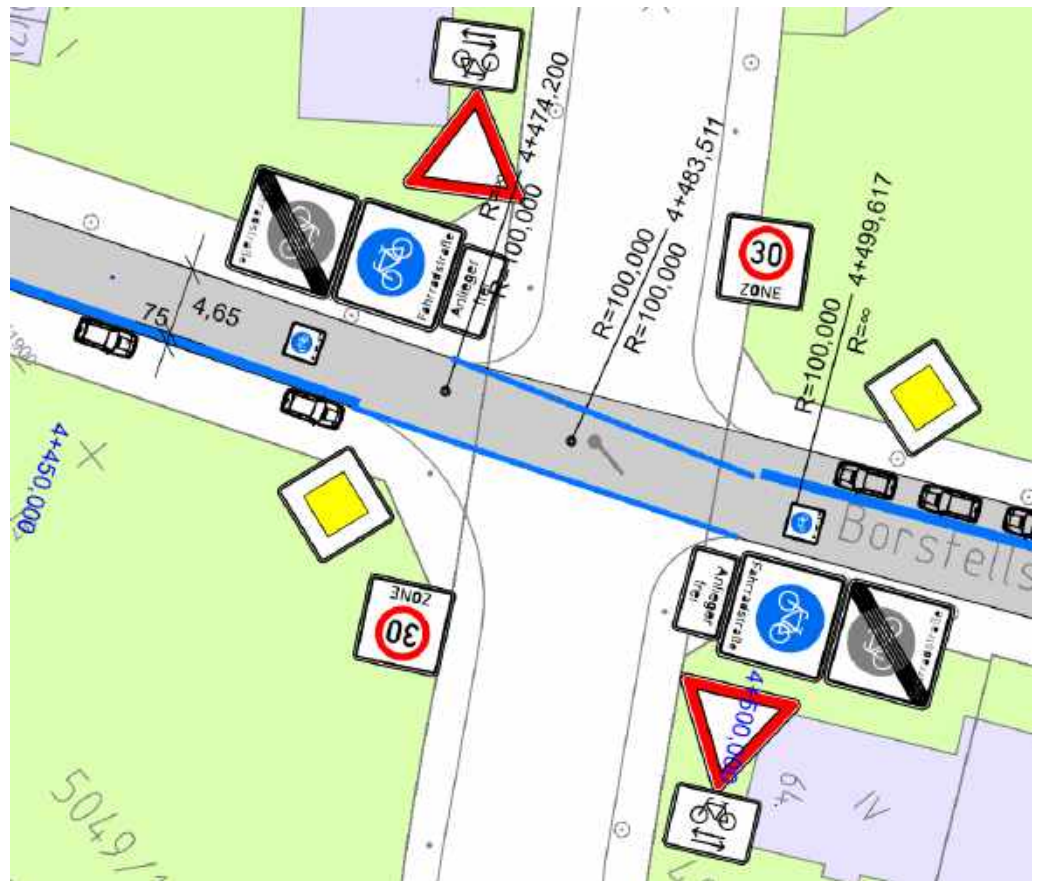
Beschilderung und Markierung einer Fahrradstraße
